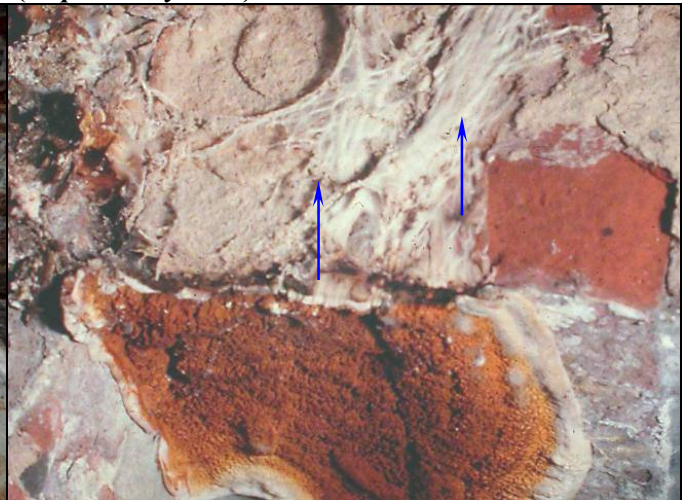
Stränge versorgen einen faltig gewundenen Fruchtkörper des Echten Hausschwammes und durchziehen das Mauerwerk (↑); das Mauerwerk wurde aufgeschlagen.
